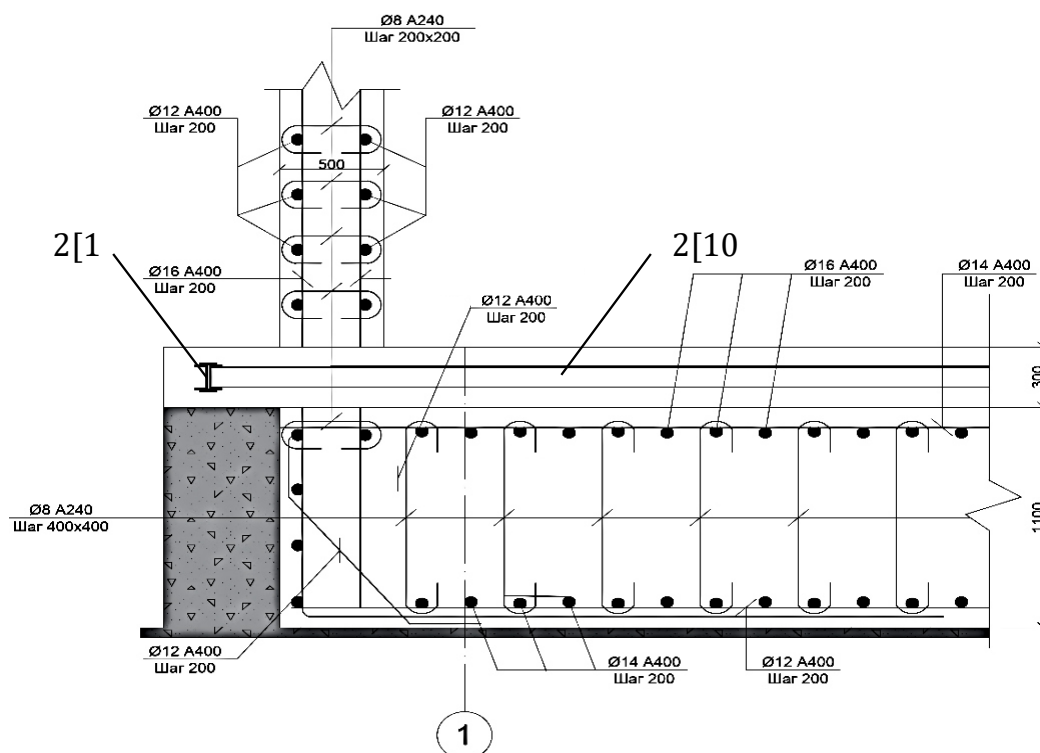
Узел сопряжения стены и дна методом усиления плитного фундамента бетонированием полос из железобетона с двух сторон
